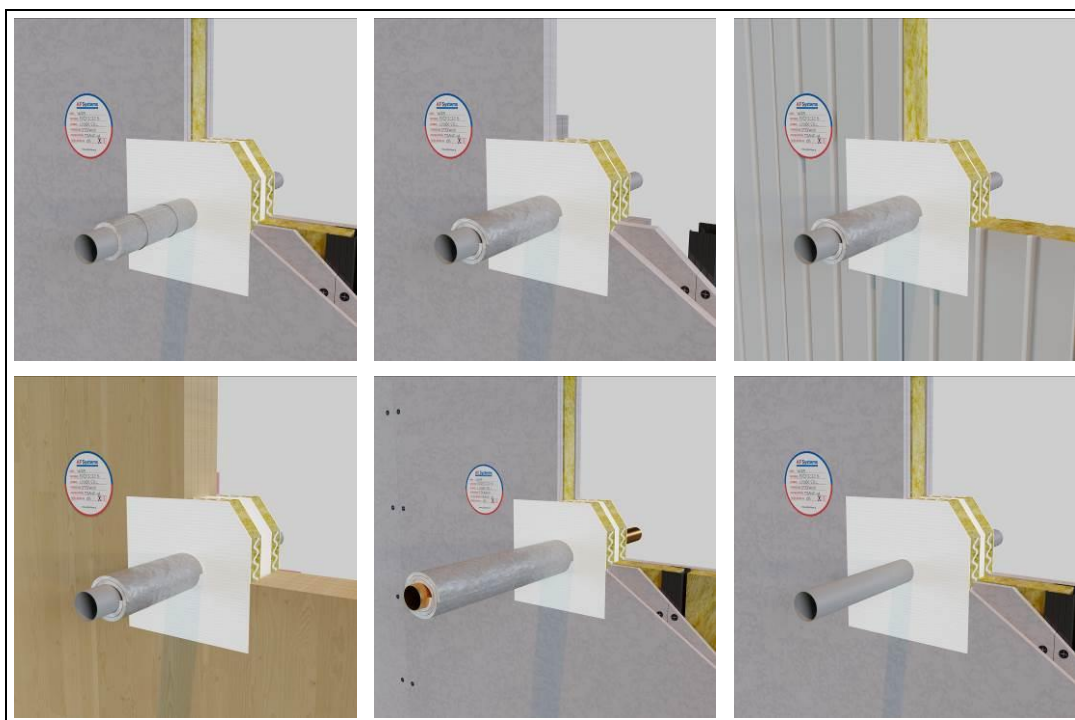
Ejemplo de sellado de tuberías metálicas no aisladas en paredes.
